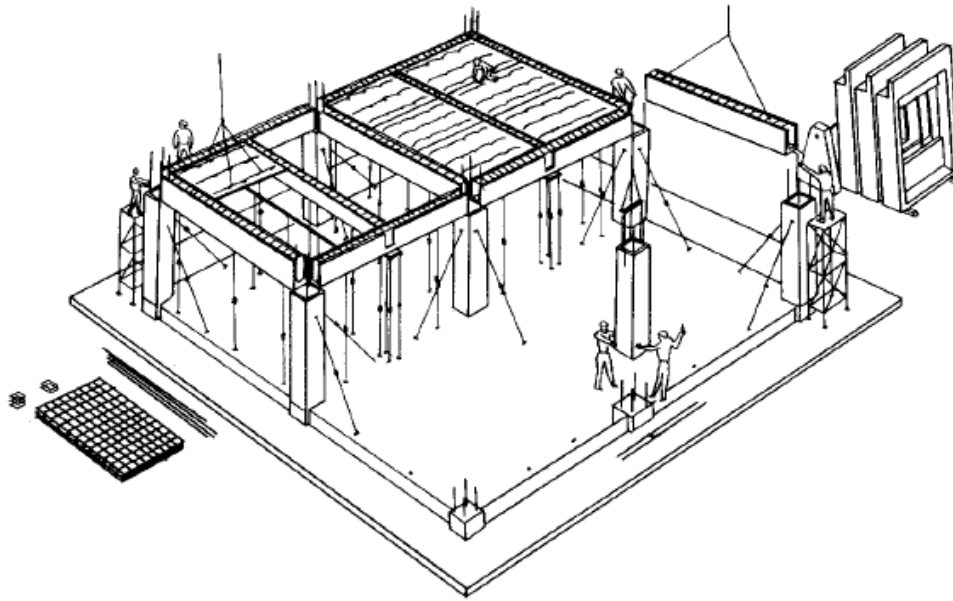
Representación de un sistemas de marcos estructurales resistentes a momento de concreto reforzado prefabricado (López et al. 2004)
